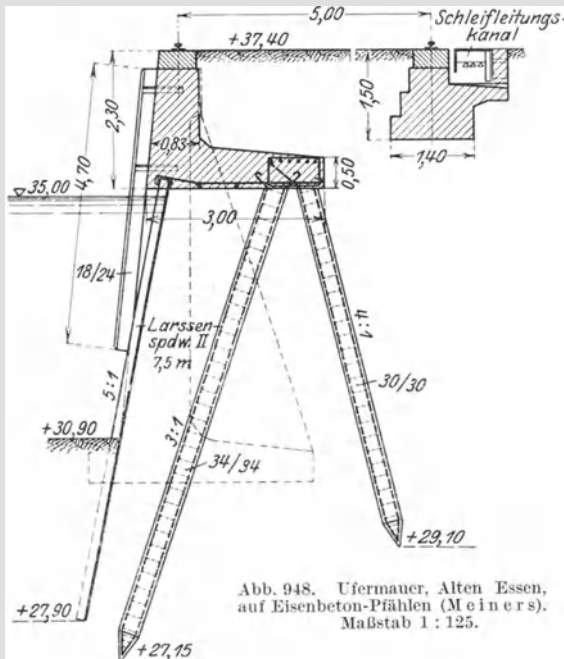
Ufermauer, Alten Essen, auf Eisenbeton-Pfählen (Meiners). Maßstab 1:125.
